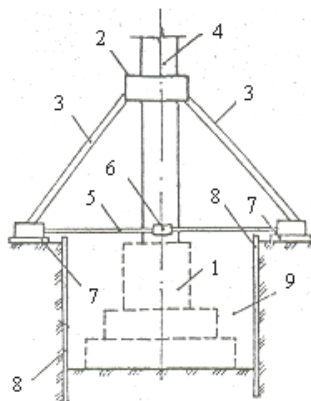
Вывешивание бетонных или металлических колонн при замене столбчатых фундаментов:
